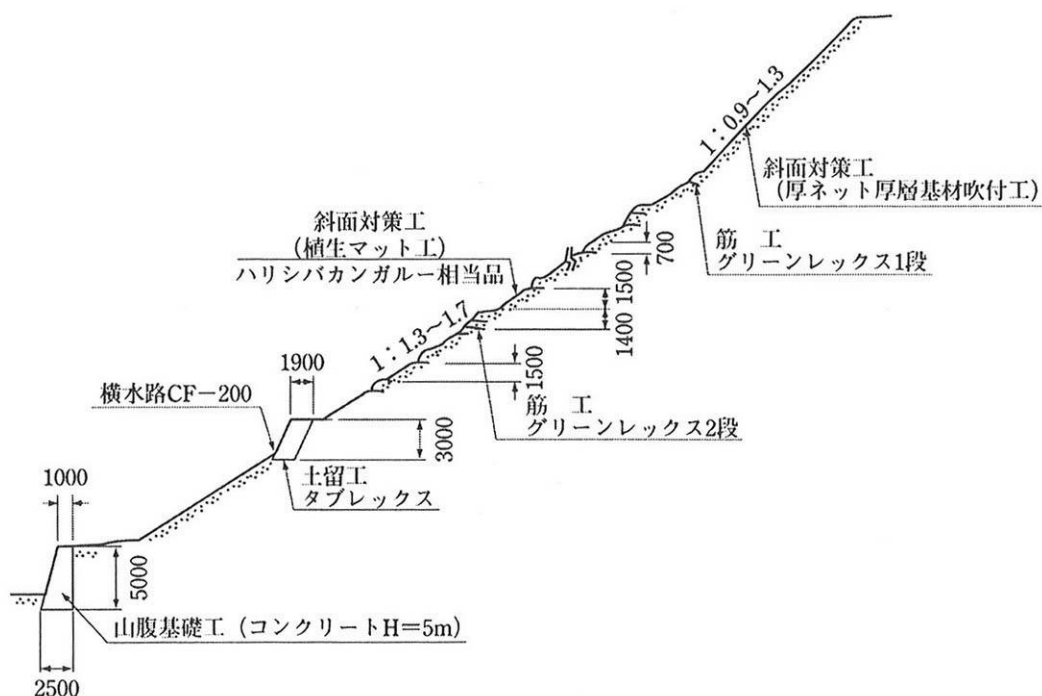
植生基礎工を主とした山腹工（施工例）
